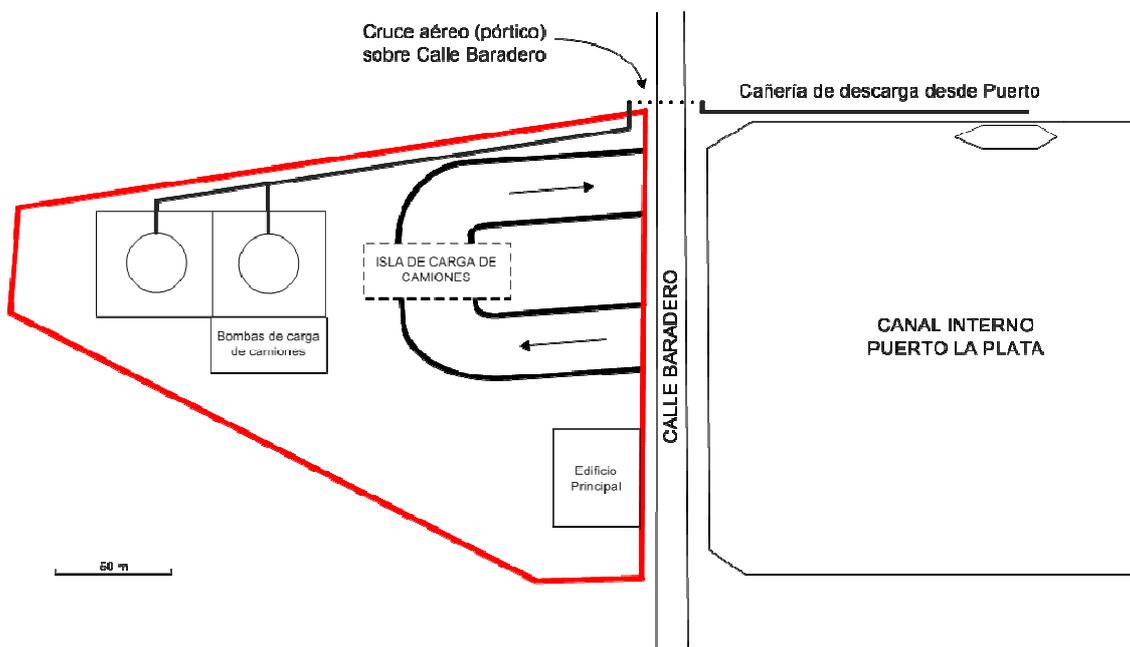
ESQUEMA DE IMPLANTACIÓN DE LA NUEVA PLANTA
